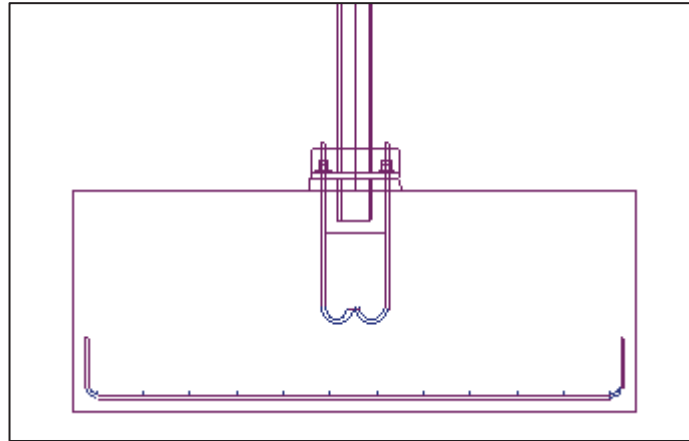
Detalle de las zapatas de los pórticos hastiales de los bloques de cebo 1 y 2.
